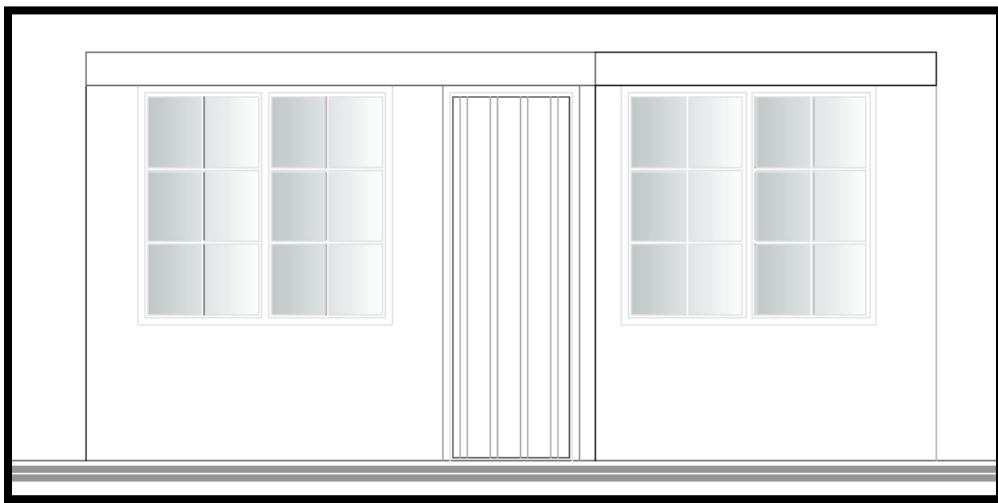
Plano Arquitectónico VIS C.I.U (CIU, 2016)
